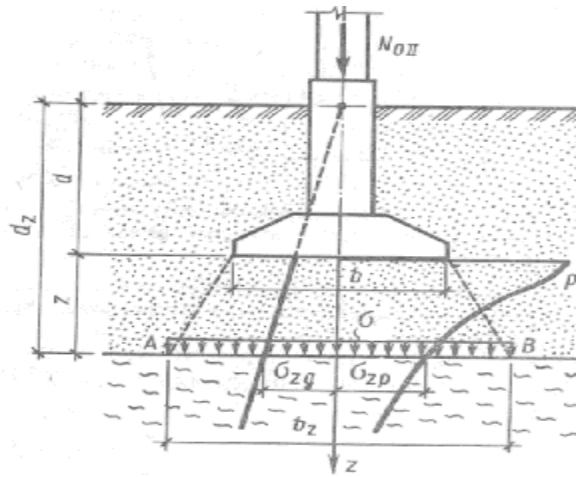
Расчётная схема к проверке давления на подстилающий слой слабого грунта.
